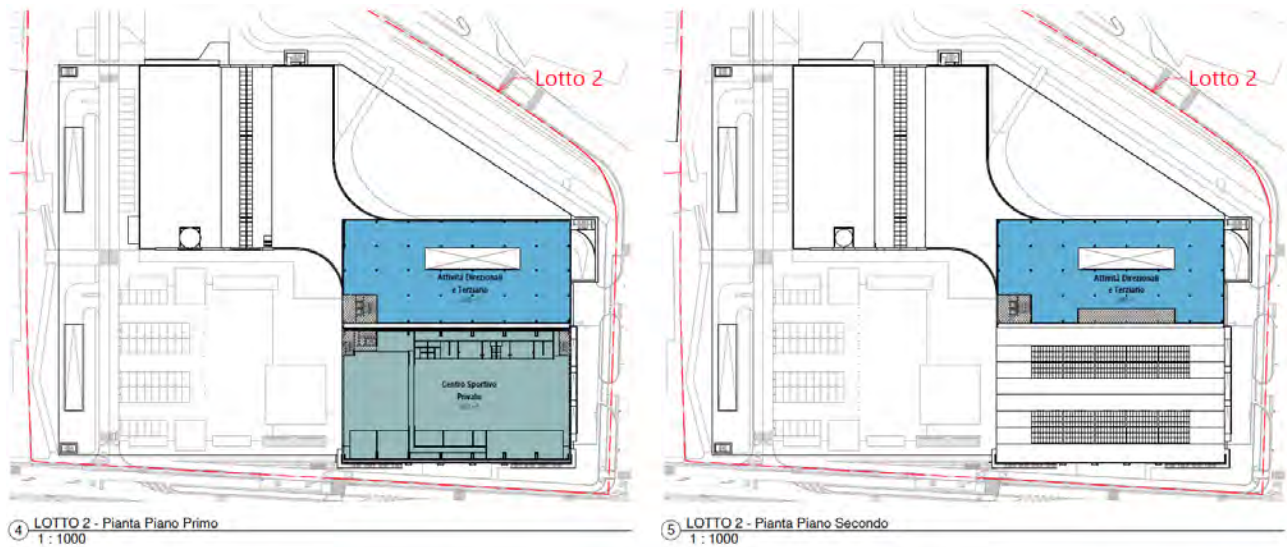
Stralcio piante del Complesso Multifunzionale - Piano primo e Piano secondo
